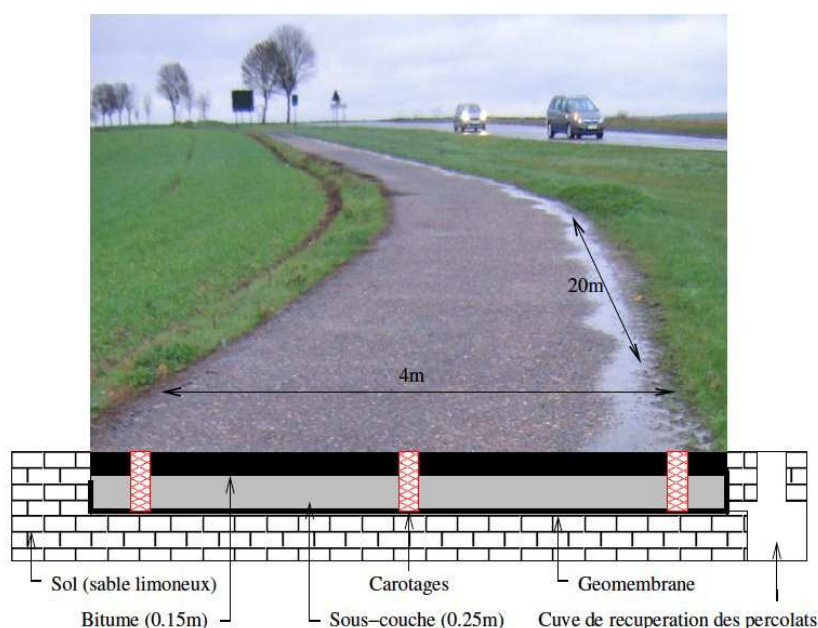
Photographie et schéma en coupe de la section de route instrumentée.
